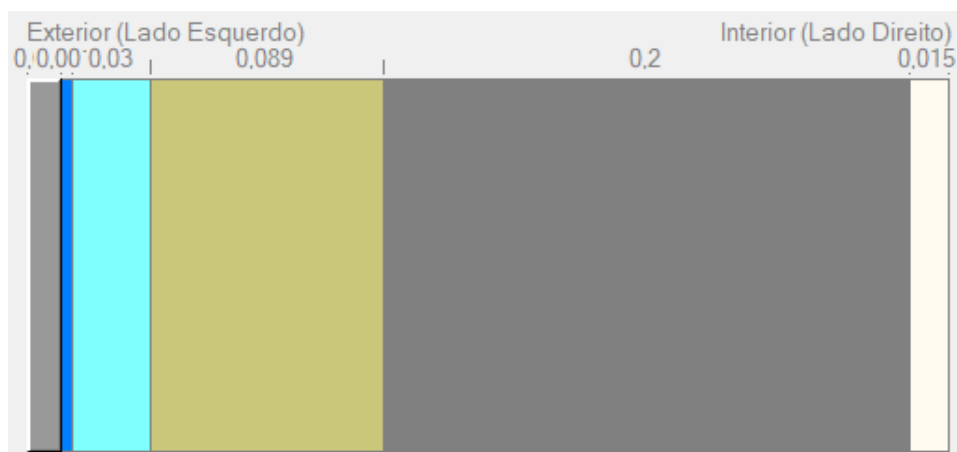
Esquema construtivo da cobertura inclinada 6
